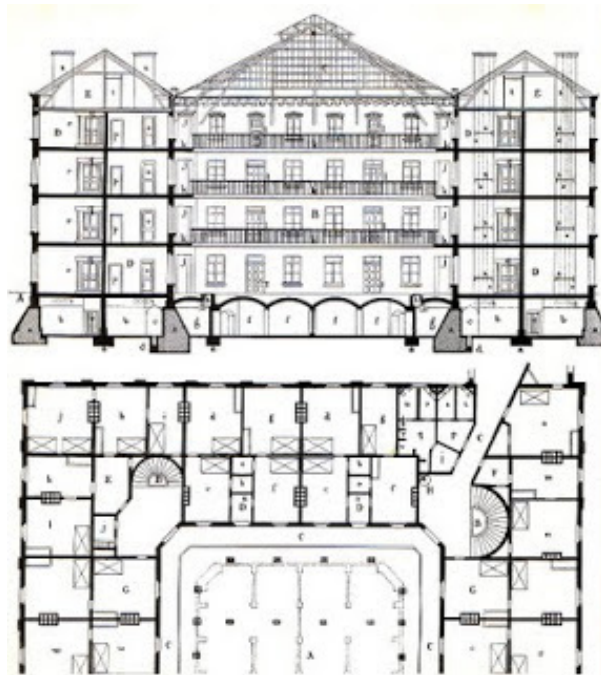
| Planta y corte de Familisterio de Godin| www.proyectualdos2011.blogspot.com/
